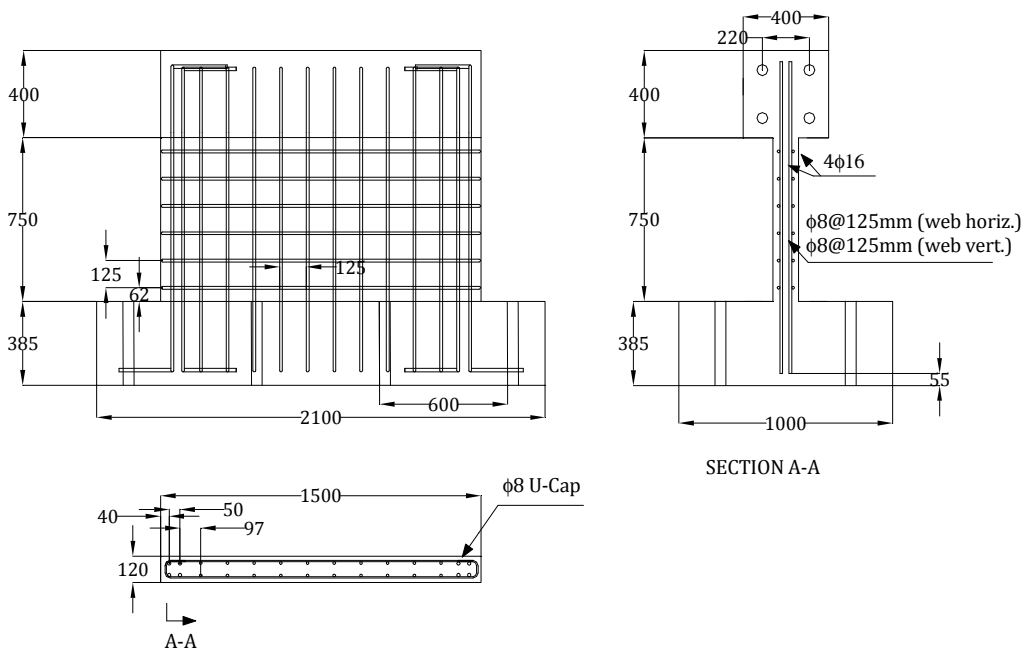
Geometría y detalle de armadura de muro Tipo 2.
